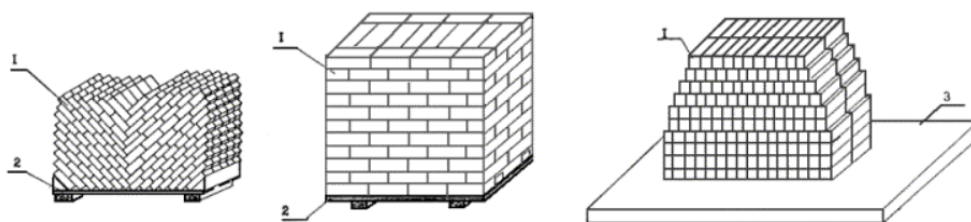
Схема складирования камней на поддонах: 1 – камень; 2 – поддон; 3 – железобетонная плита.
